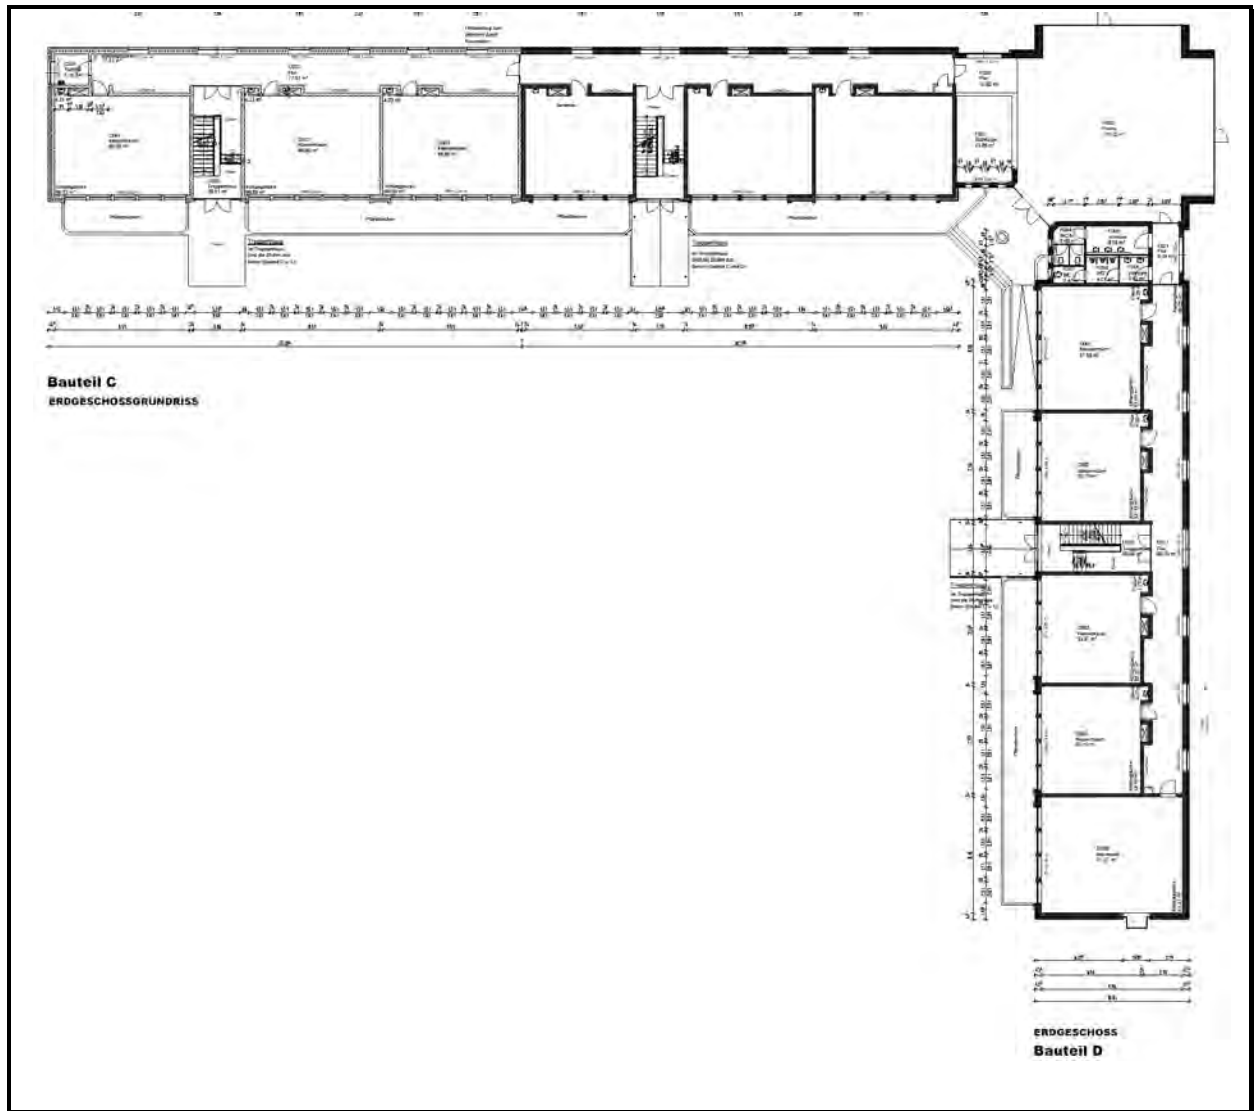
Friedrich-Ebert-Realschule: Erdgeschossgrundriss Bauteile C, D, Forum
